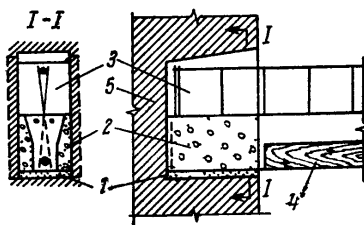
Заделка в гнезде железобетонной балки неполного сечения
